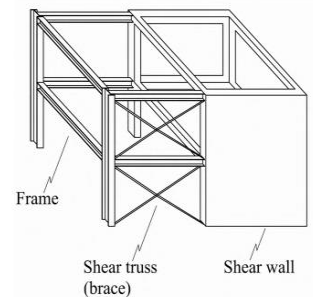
Châssis rigide, poutre de cisaillement (contreventement), paroi de cisaillement
